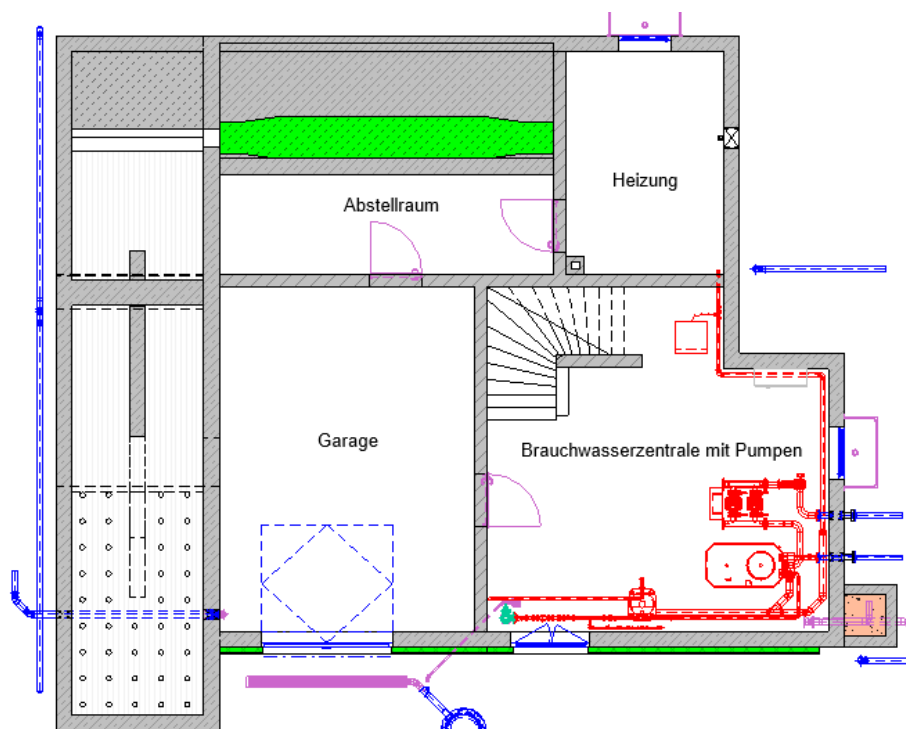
Grundriss Betriebsgebäude UG mit Brauchwasserzentrale
